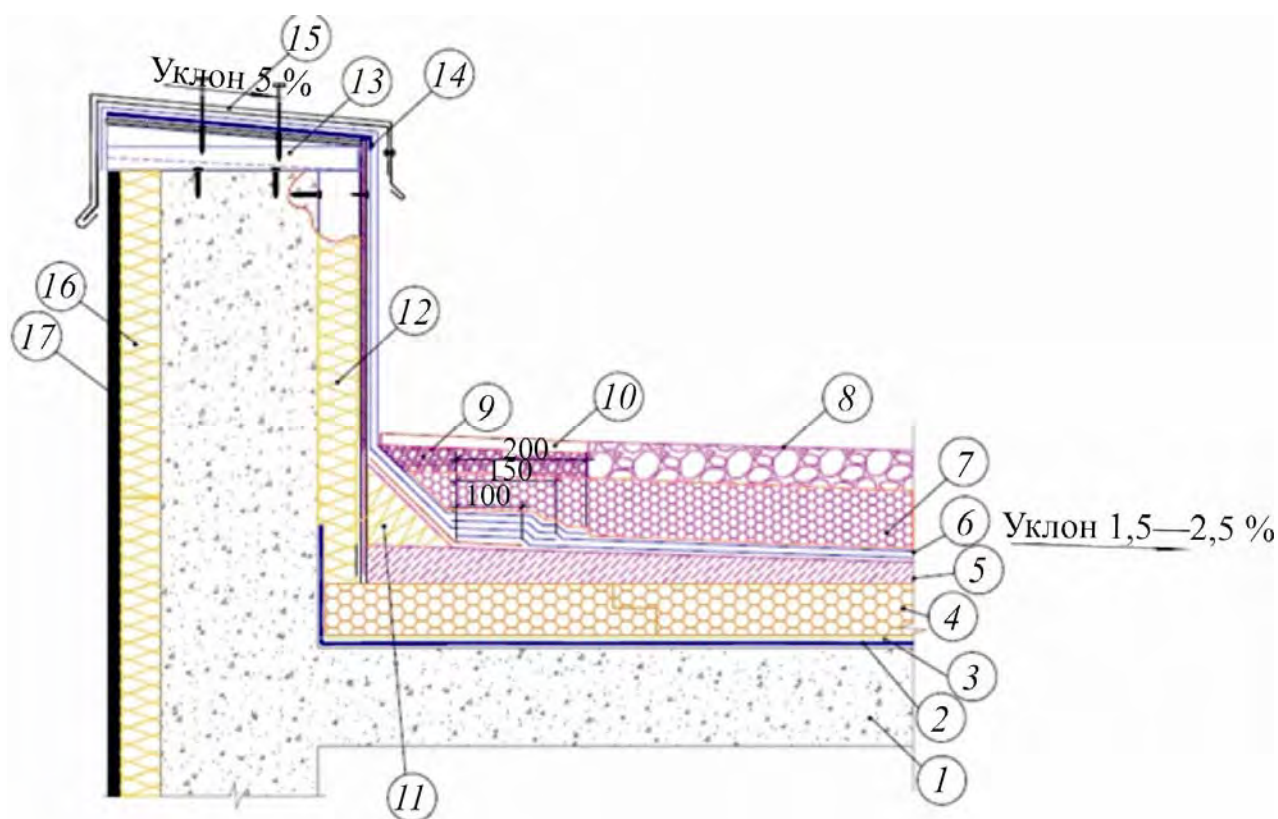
Узел примыкания к парапету: 1 — плита перекрытия; 2 — грунтовочный слой; 3 — пароизоляция; 4 — имеющийся утеплитель; 5 — стяжка; 6 — гидроизоляционный ковер; 7 — новая теплоизоляция (экструдированный пенополистерол); 8 — гравий; 9 — дренарующий слой (гравий диаметром 4...8 мм); 10 — тротуарная плитка (по всему периметру кровли); 11 — клин из теплоизоляционного материала; 12 — внутреннее утепление парапета (экструдированный пенополистирол); 13 — деревянный брус; 14 — крепежный профиль; 15 — накрывающий металлический профиль; 16 — внешняя теплоизоляция стены и парапета; 17 — навесной фасад
